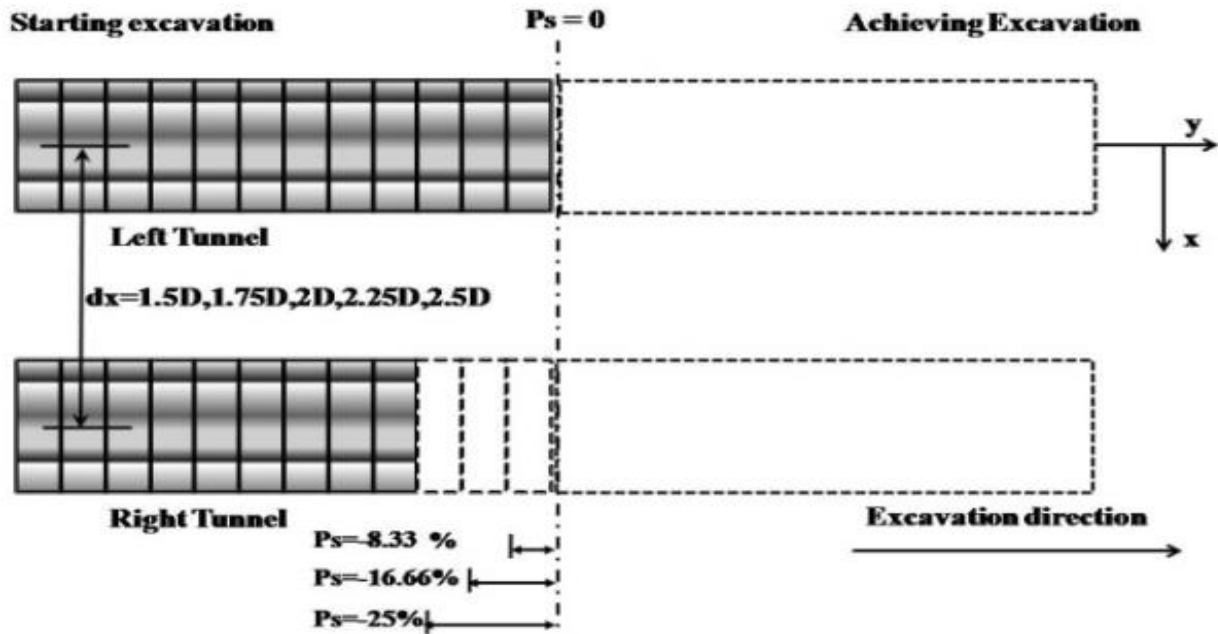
(b) : Vue en plan des tunnels jumeaux pour le cas 1
